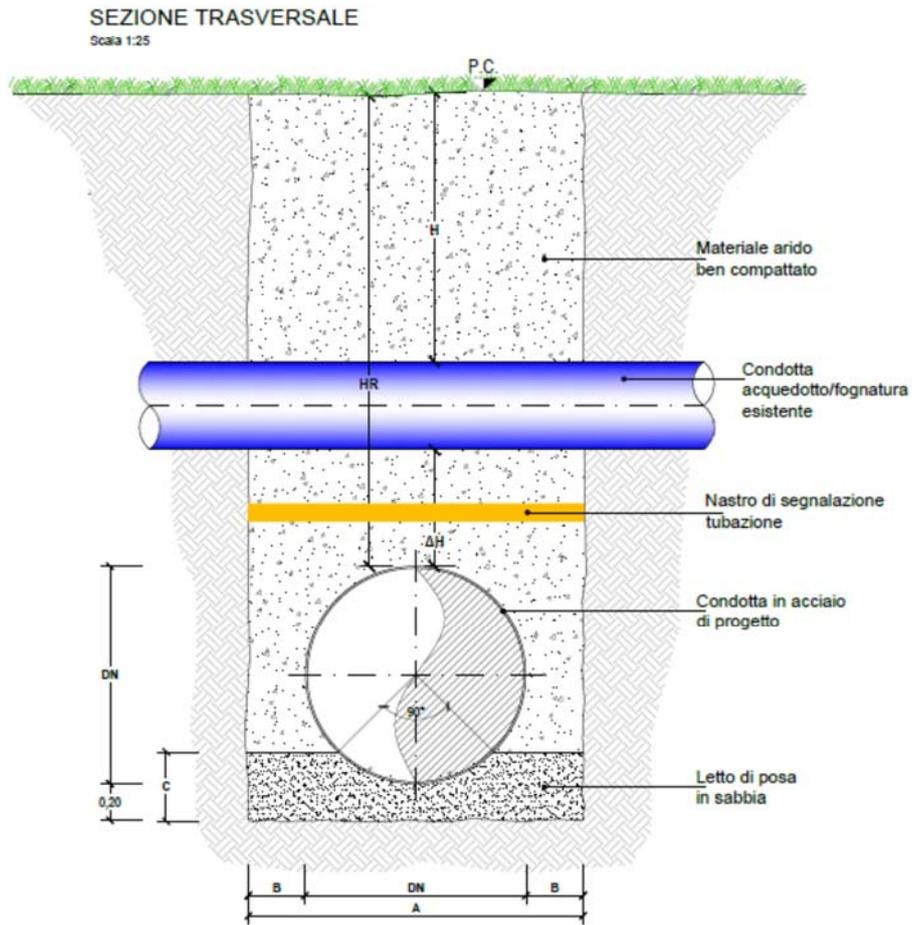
Sezione tipologica trasversale di attraversamento (sottopasso)
